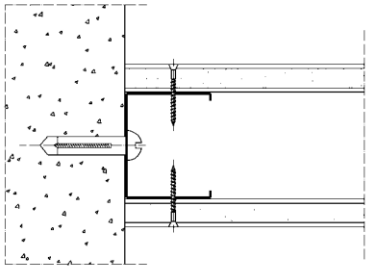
Départ de cloison sur maçonnerie pleine ou béton – Fixation par chevillage
